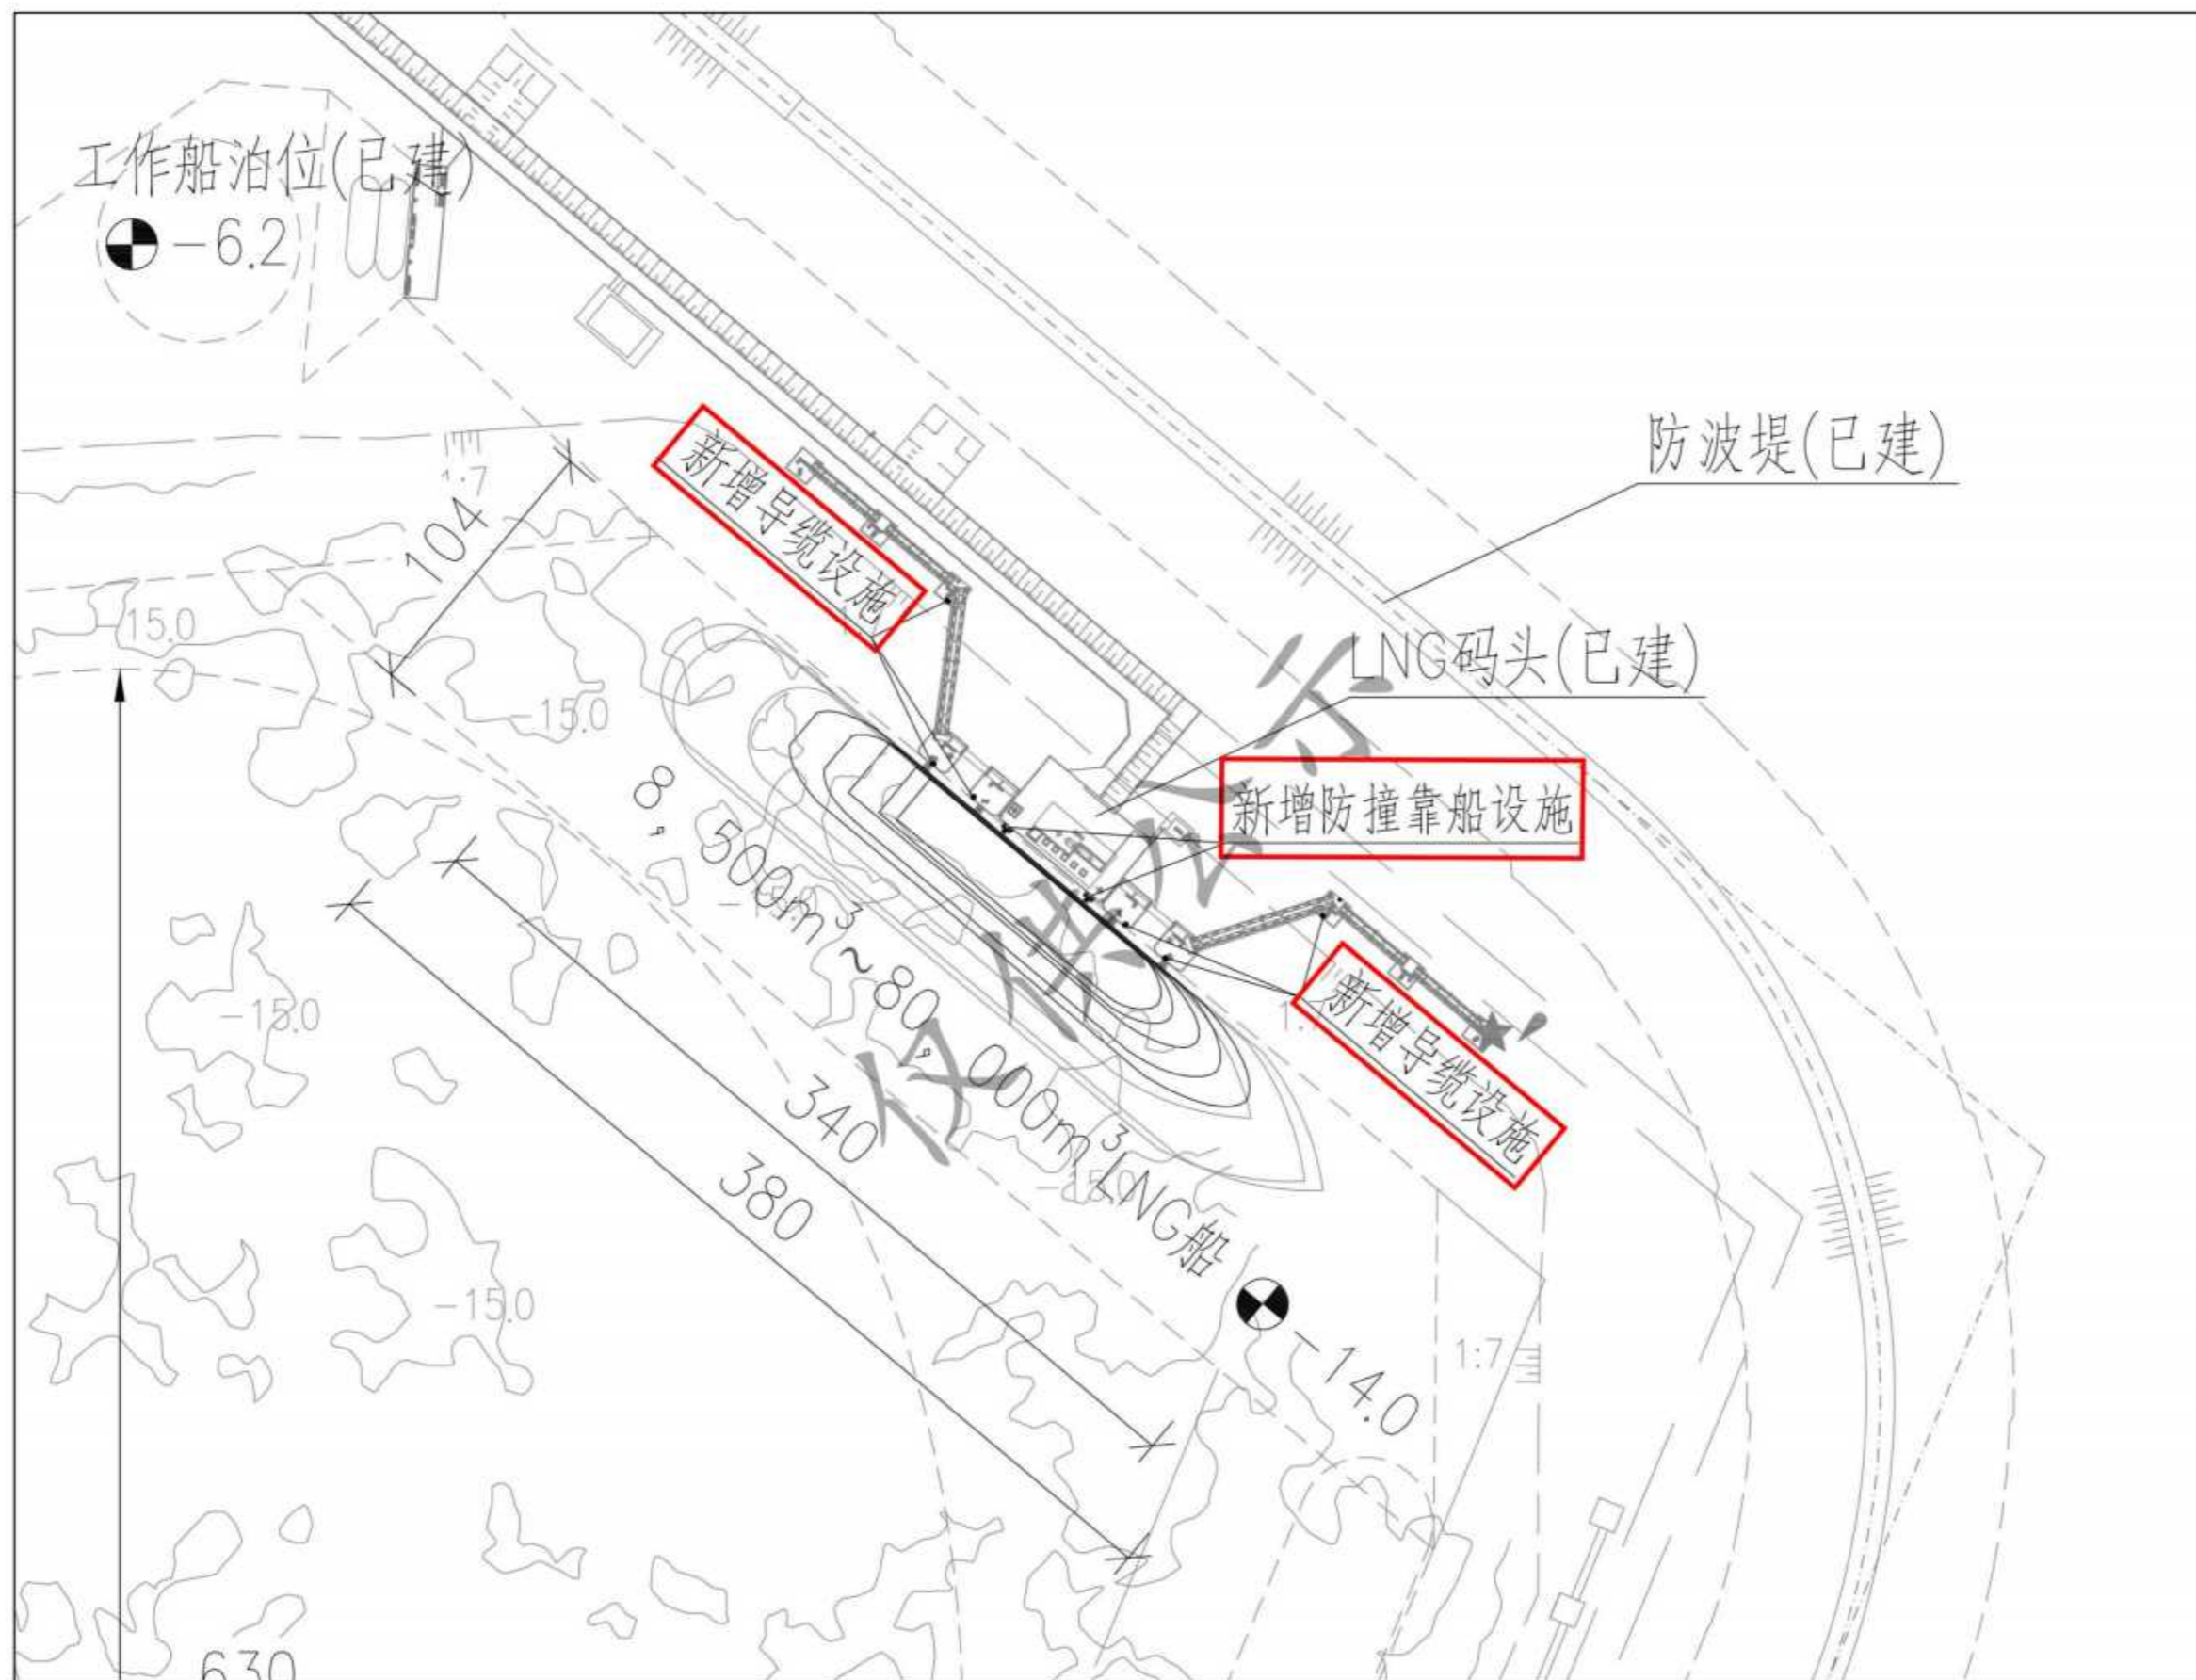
码头改建工程放大平面布置图（红框为本次改建内容）
